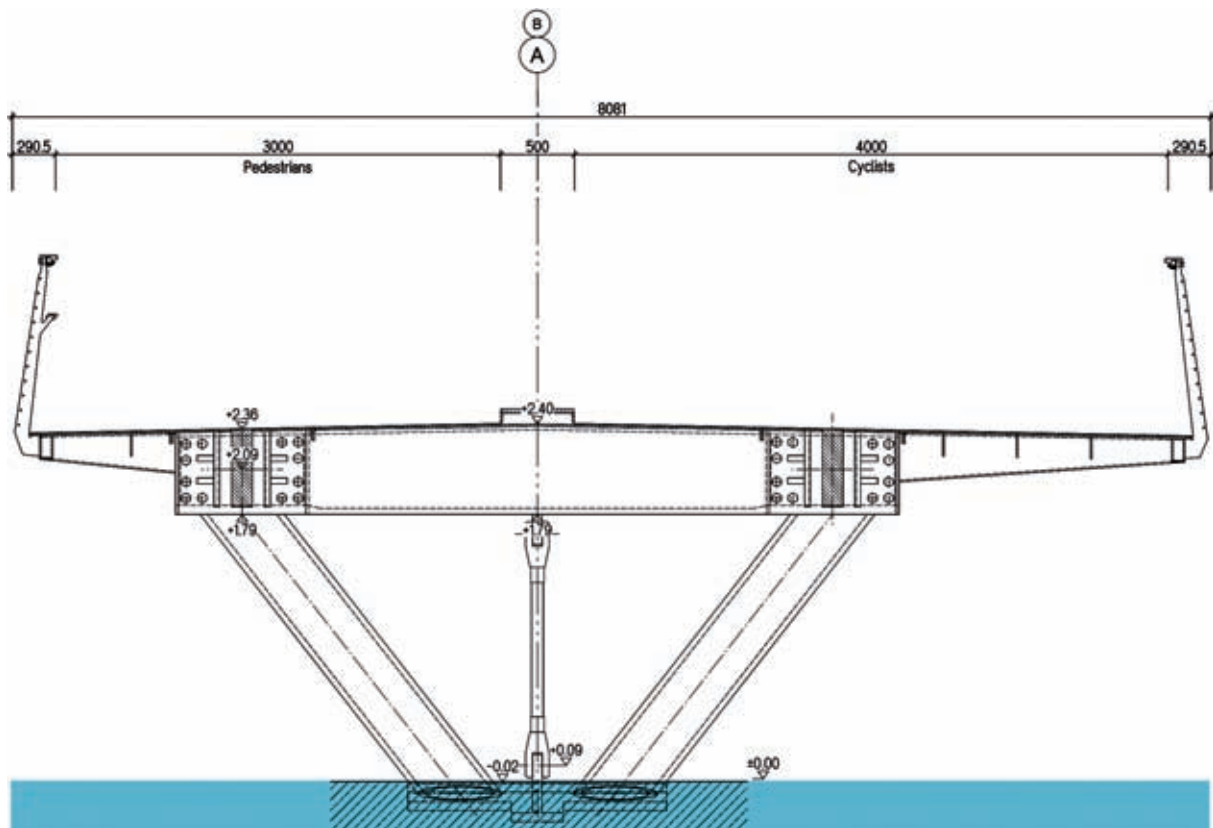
Querschnitt der Mittelplattform mit Befestigung der Drehlager
